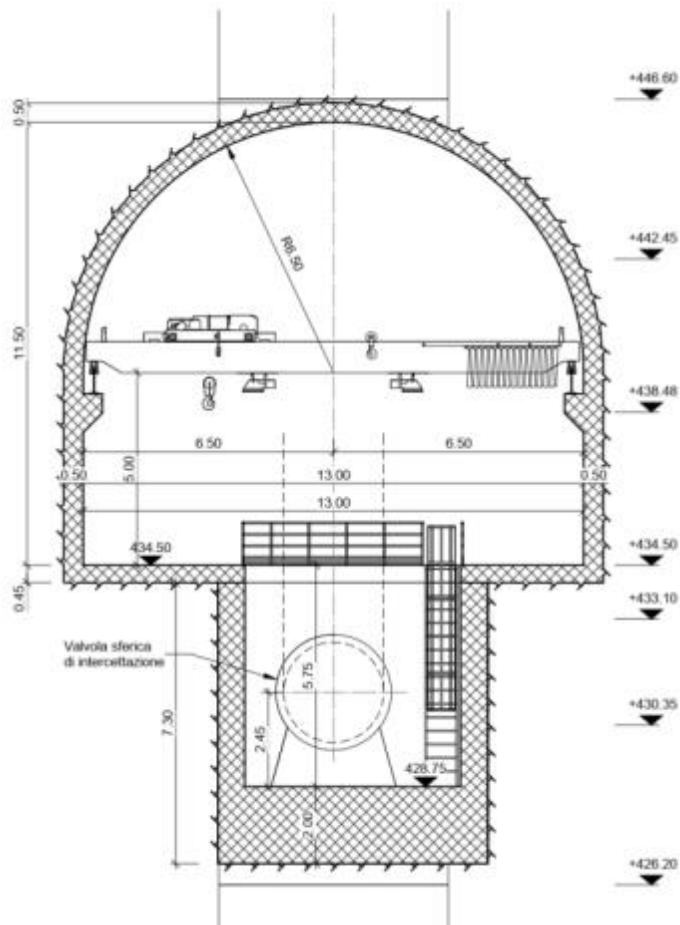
Caverna per la realizzazione del nuovo innesto sul pozzo verticale – sezione
